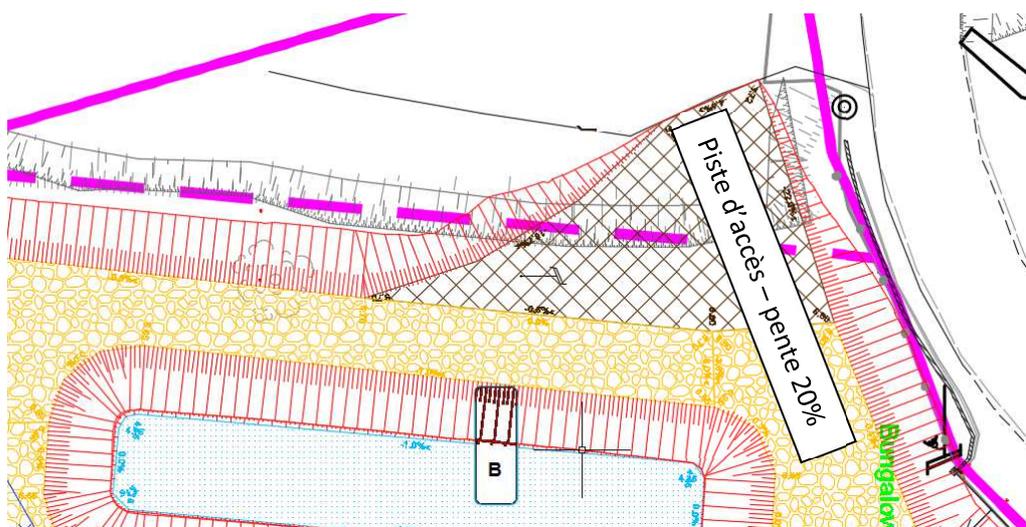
Extrait du plan avec localisation des rampes (source : SAFEGE 2018)
